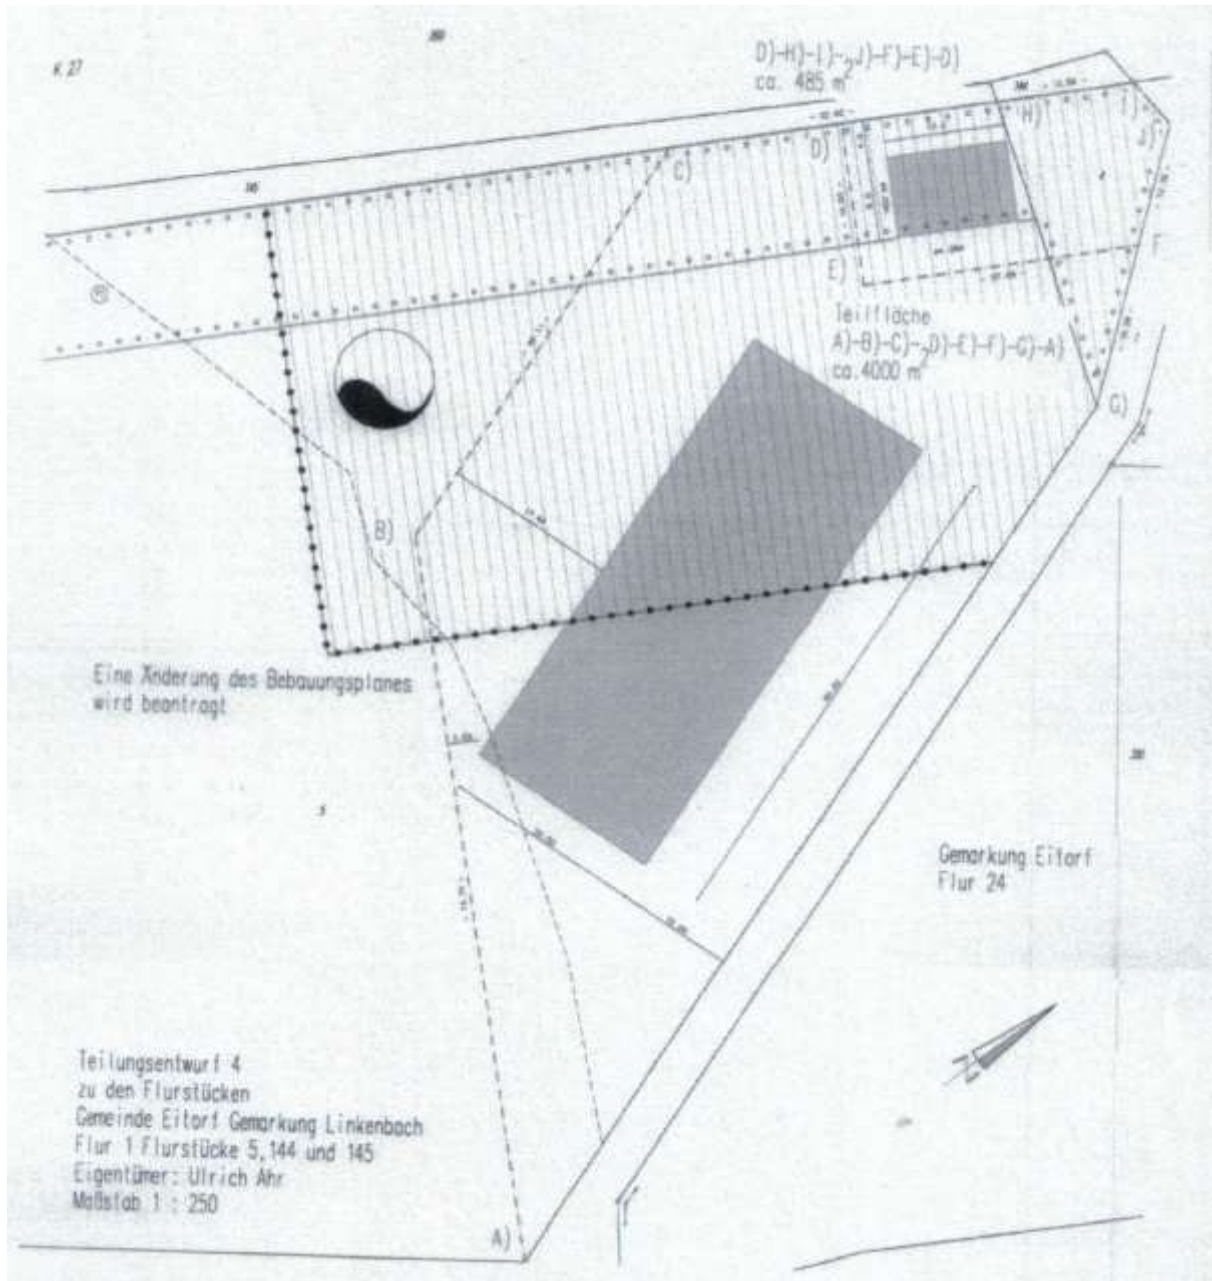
Entwurf des Lageplans der geplanten Hallen.
